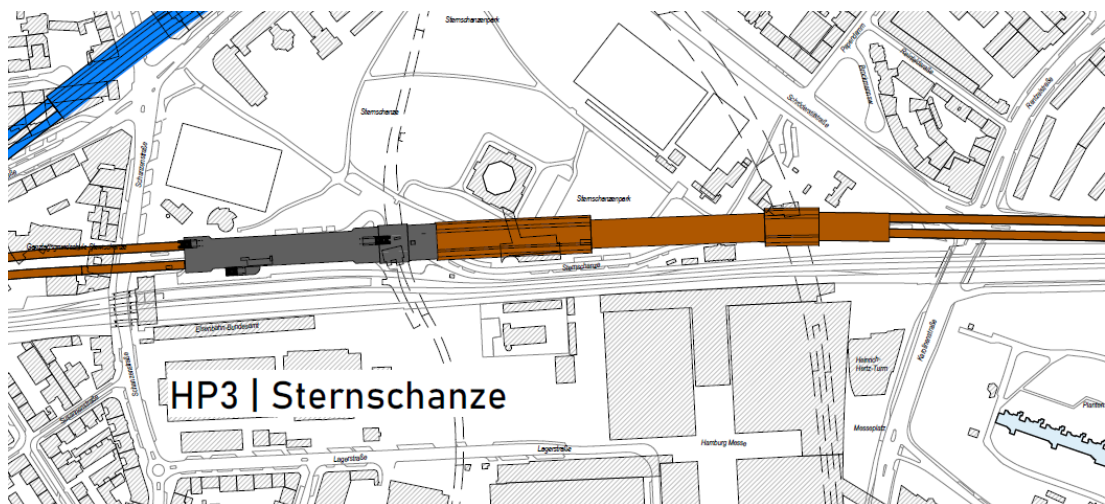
Lageplan Stationsbauwerk HP 3 Sternschanze, Variante 3 (braun) (Variantenstudie).
